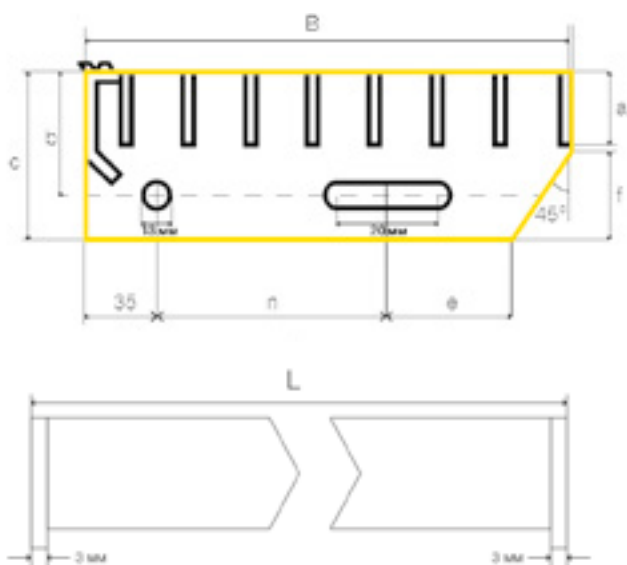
Винтовая ступень из сварного настила SP
